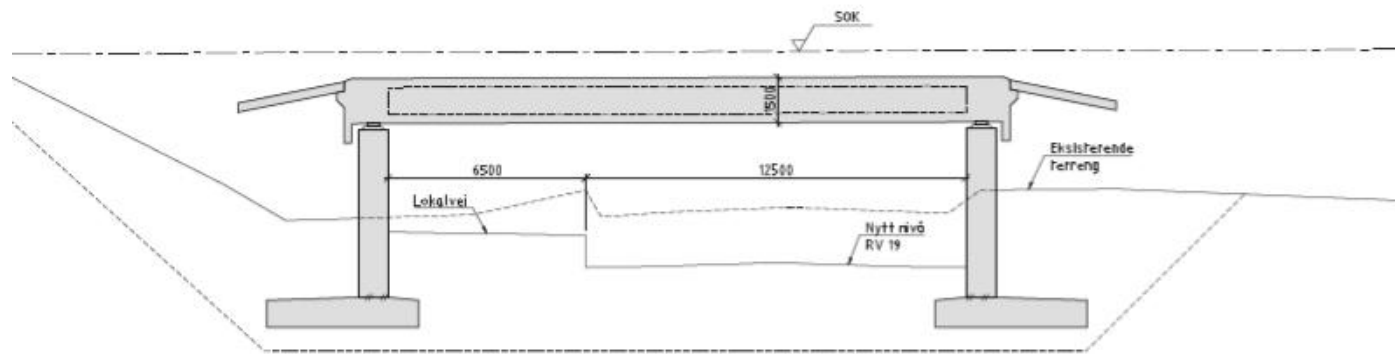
Tverrsnitt for løsning med betongkulvert for rv.19
